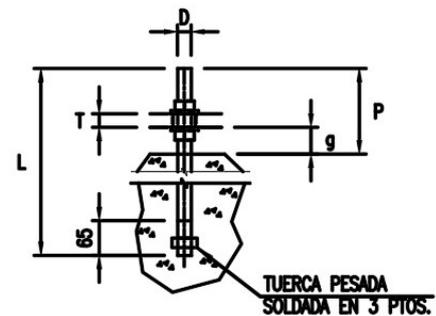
Detalle de pernos de anclaje - Edificio con estructuras metálicas.
